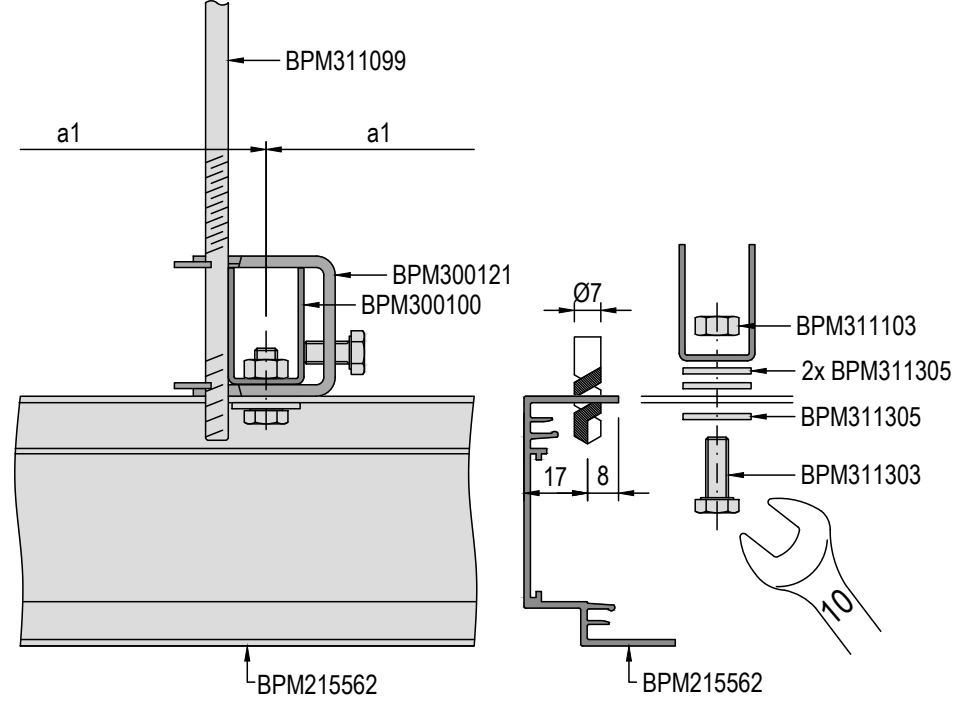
UDETAIL KŘÍŽOVÉHO NAPOJENÍ U-PROFILŮ
